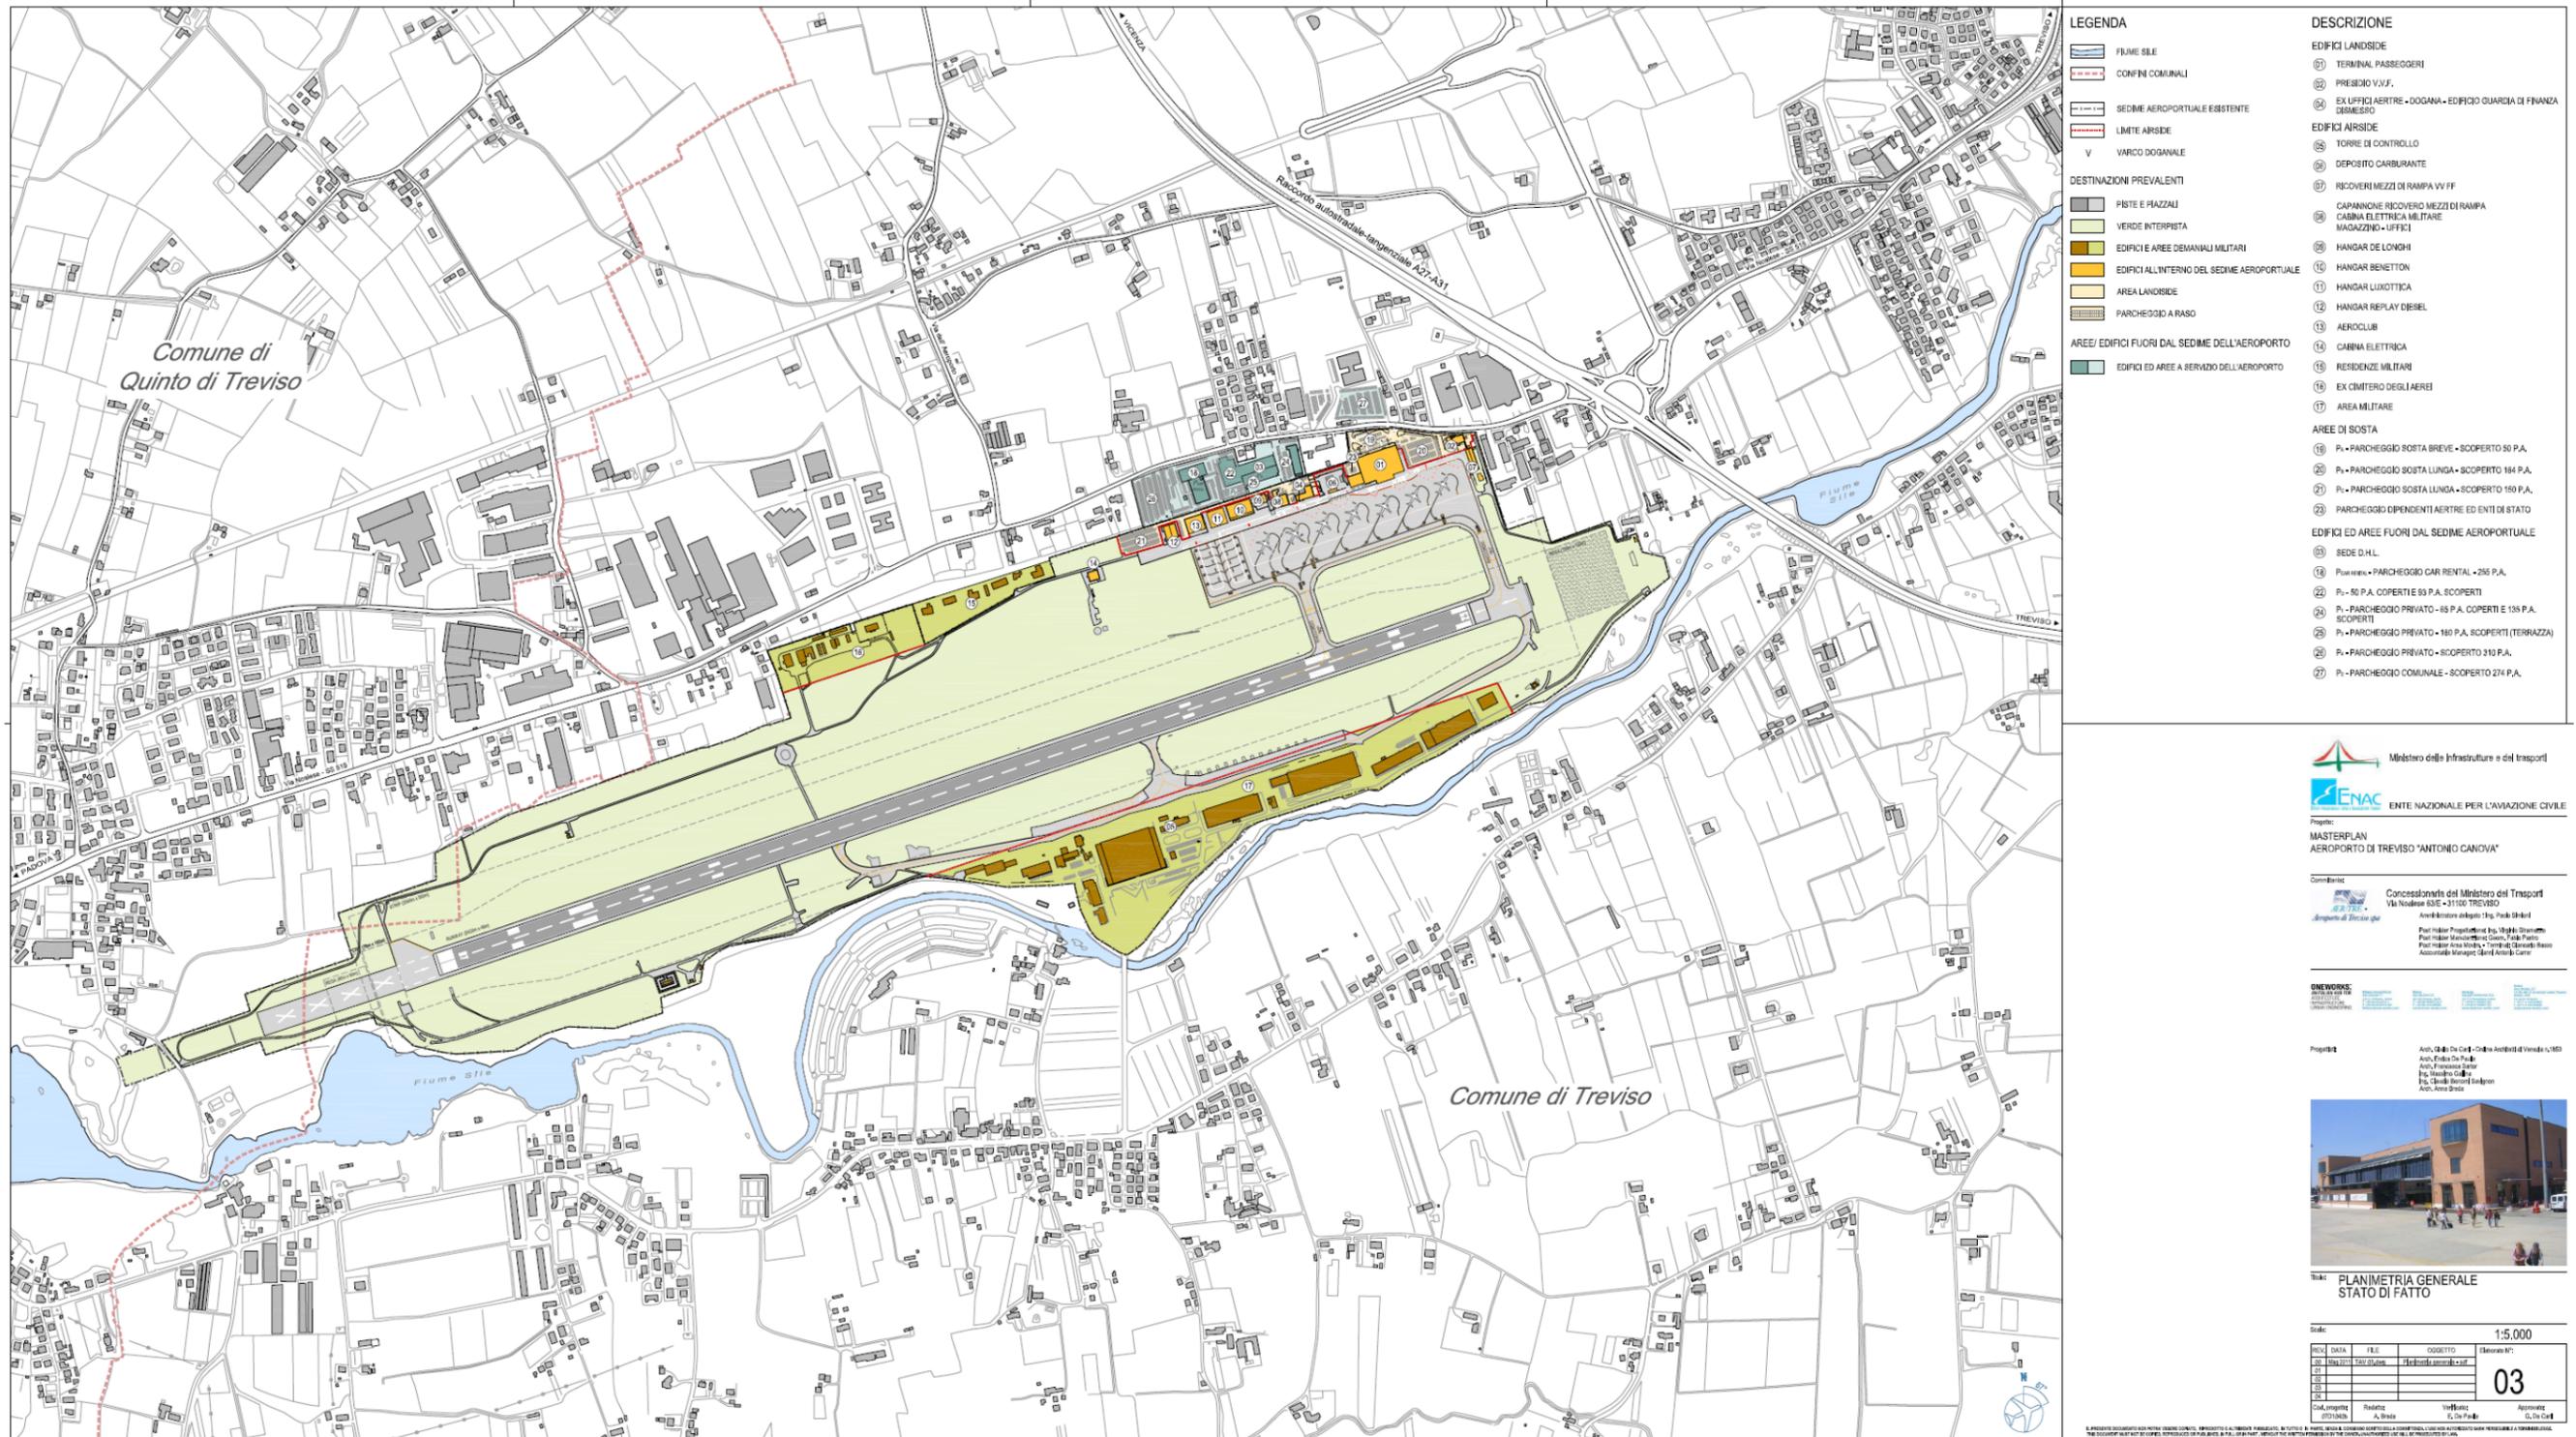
Planimetria generale stato di fatto (Fonte: Aeroporto di Treviso "Antonio Canova" Master Plan: relazione e piano degli investimenti).
